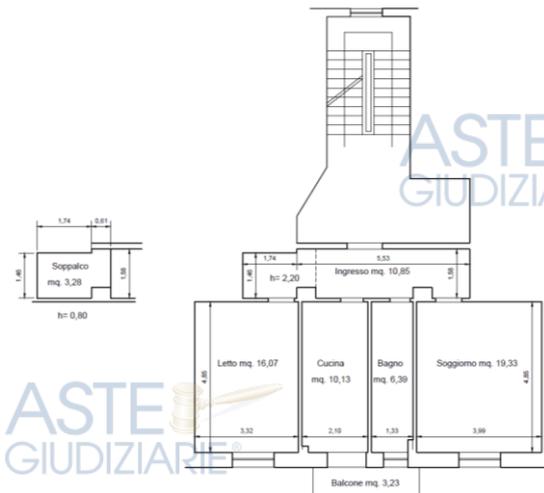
Planimetria rilevata dell'appartamento - non in scala
